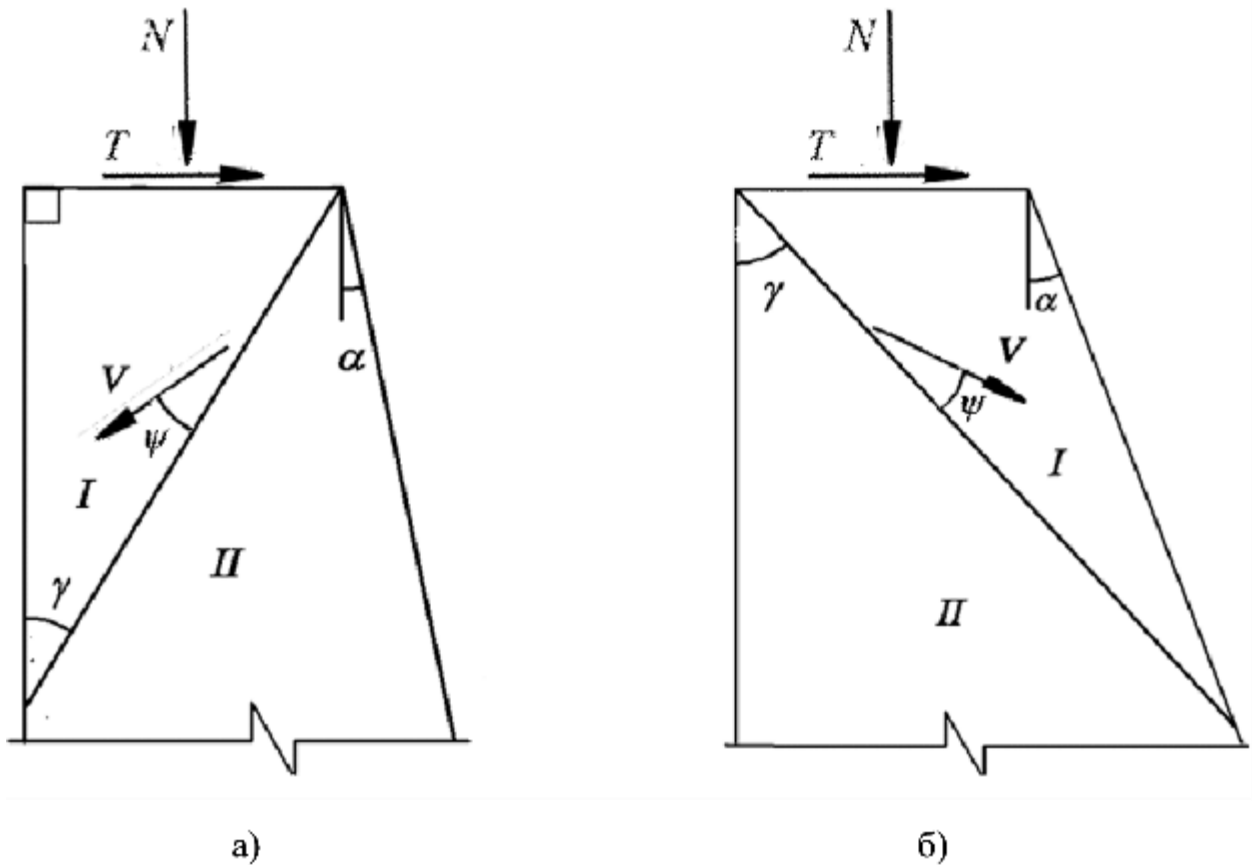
Кінематичні схеми руйнування бетонного клину при дії вертикального та горизонтального навантаження: а) випадок 1; б) – випадок 2
